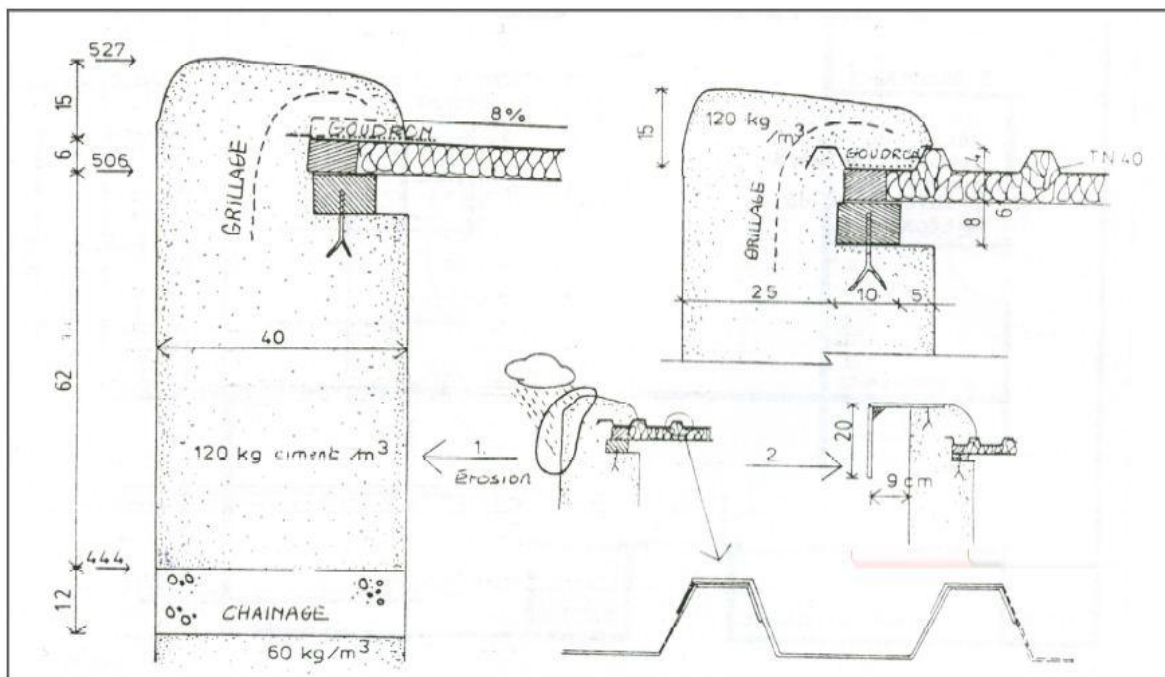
Détail constructif de la toiture [Odul, 1983].
